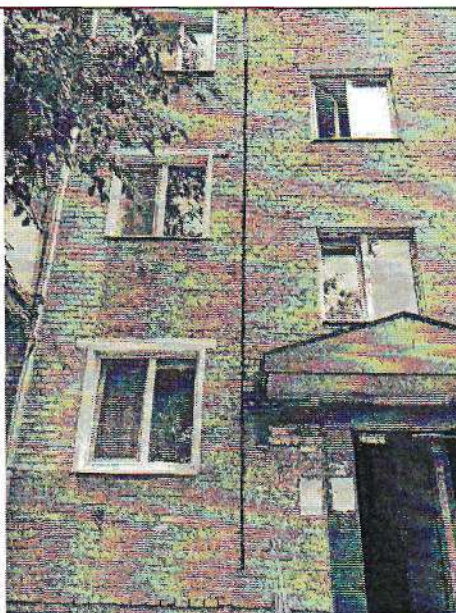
Стены. Отсутствует герметизация деформационных швов в стенах
